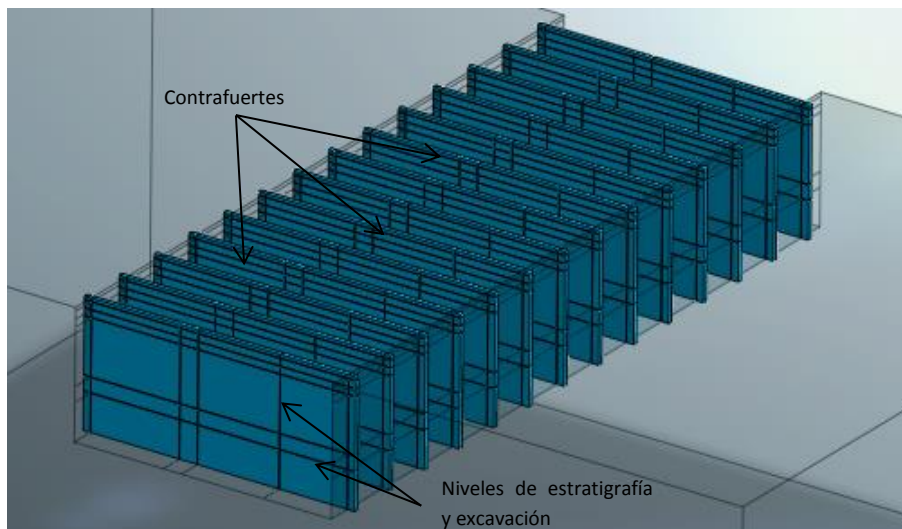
Elementos de los contrafuertes subdivididos por los niveles de estratificación y excavación. Midas GTS NX.
